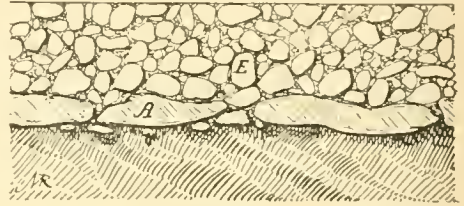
Coupe verticale d'un empierrement sur un sol meuble.
